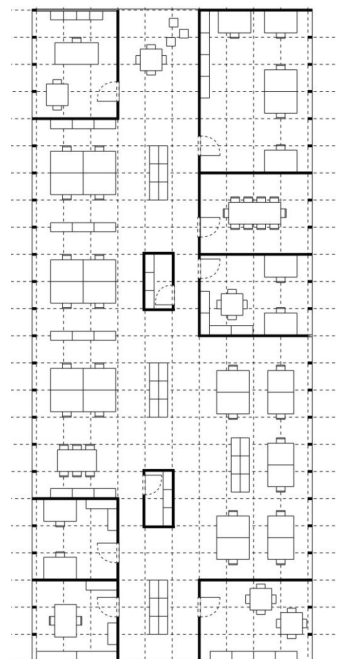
Gruppenbüro Grundrisschema ©Robert Uhl
